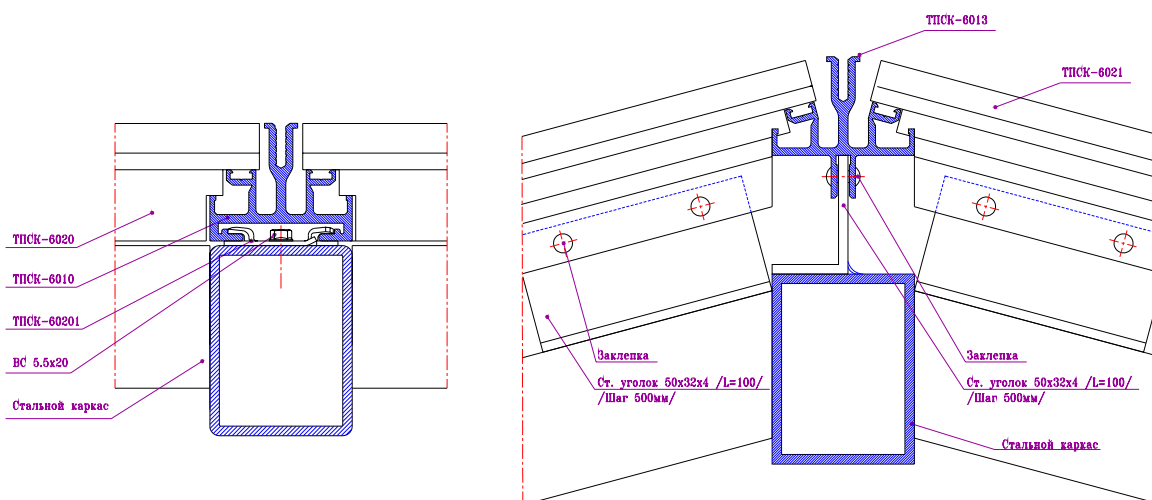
Каркас из стальных труб 60х60 и/или 60х80, соединяемых сваркой
